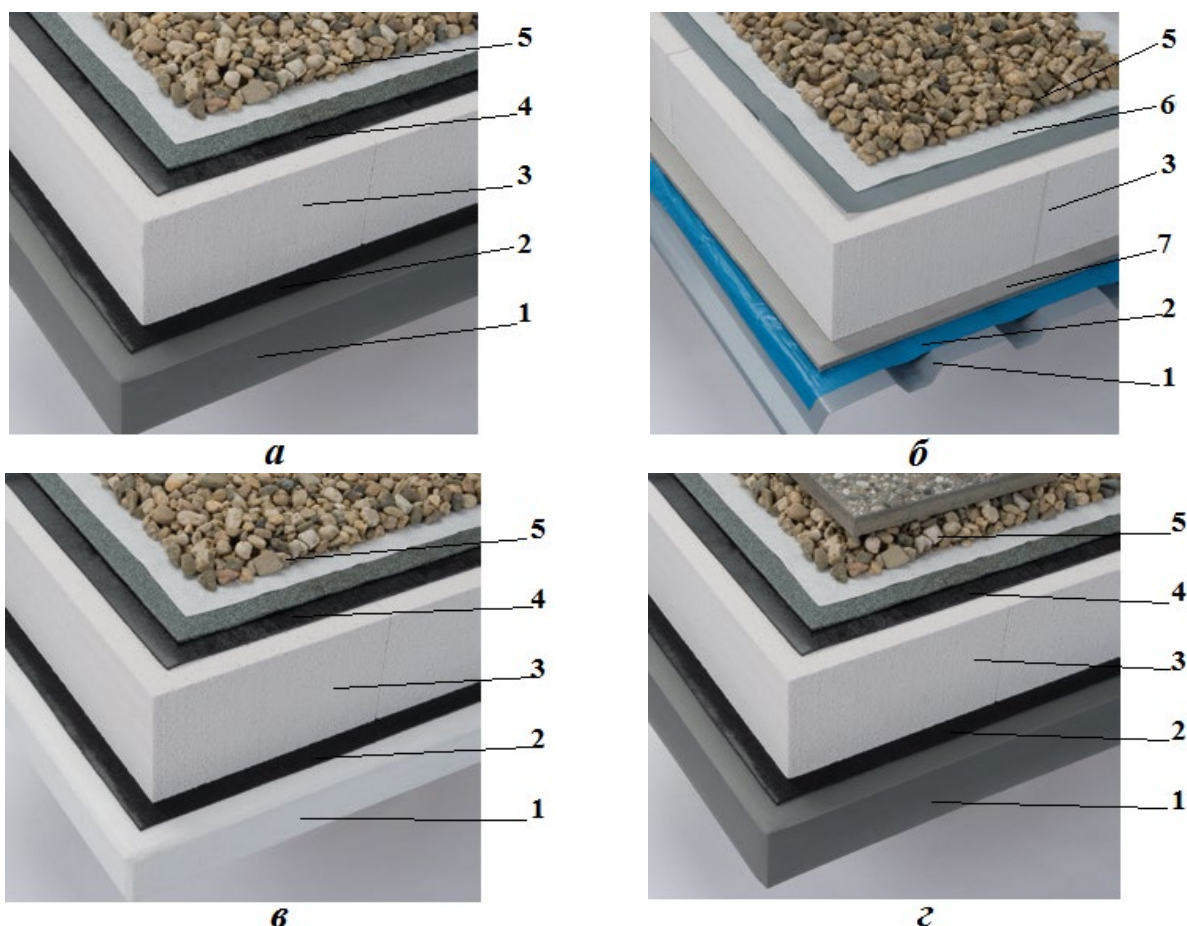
Плоская балластная кровля: а, г — по железобетонному перекрытию; б — по профилированному листу; в — по газобетонной плите; 1 — основание; 2 — пароизоляция (а, в, г — битумная; б — полиэтиленовая пленка); 3 — минеральная изоляционная плита; 4 — многослойный полимербитумный рулонный материал; 5 — балласт (гравийное покрытие): 6 — полимерная кровельная мембрана; 7 — опора для изоляционного материала
